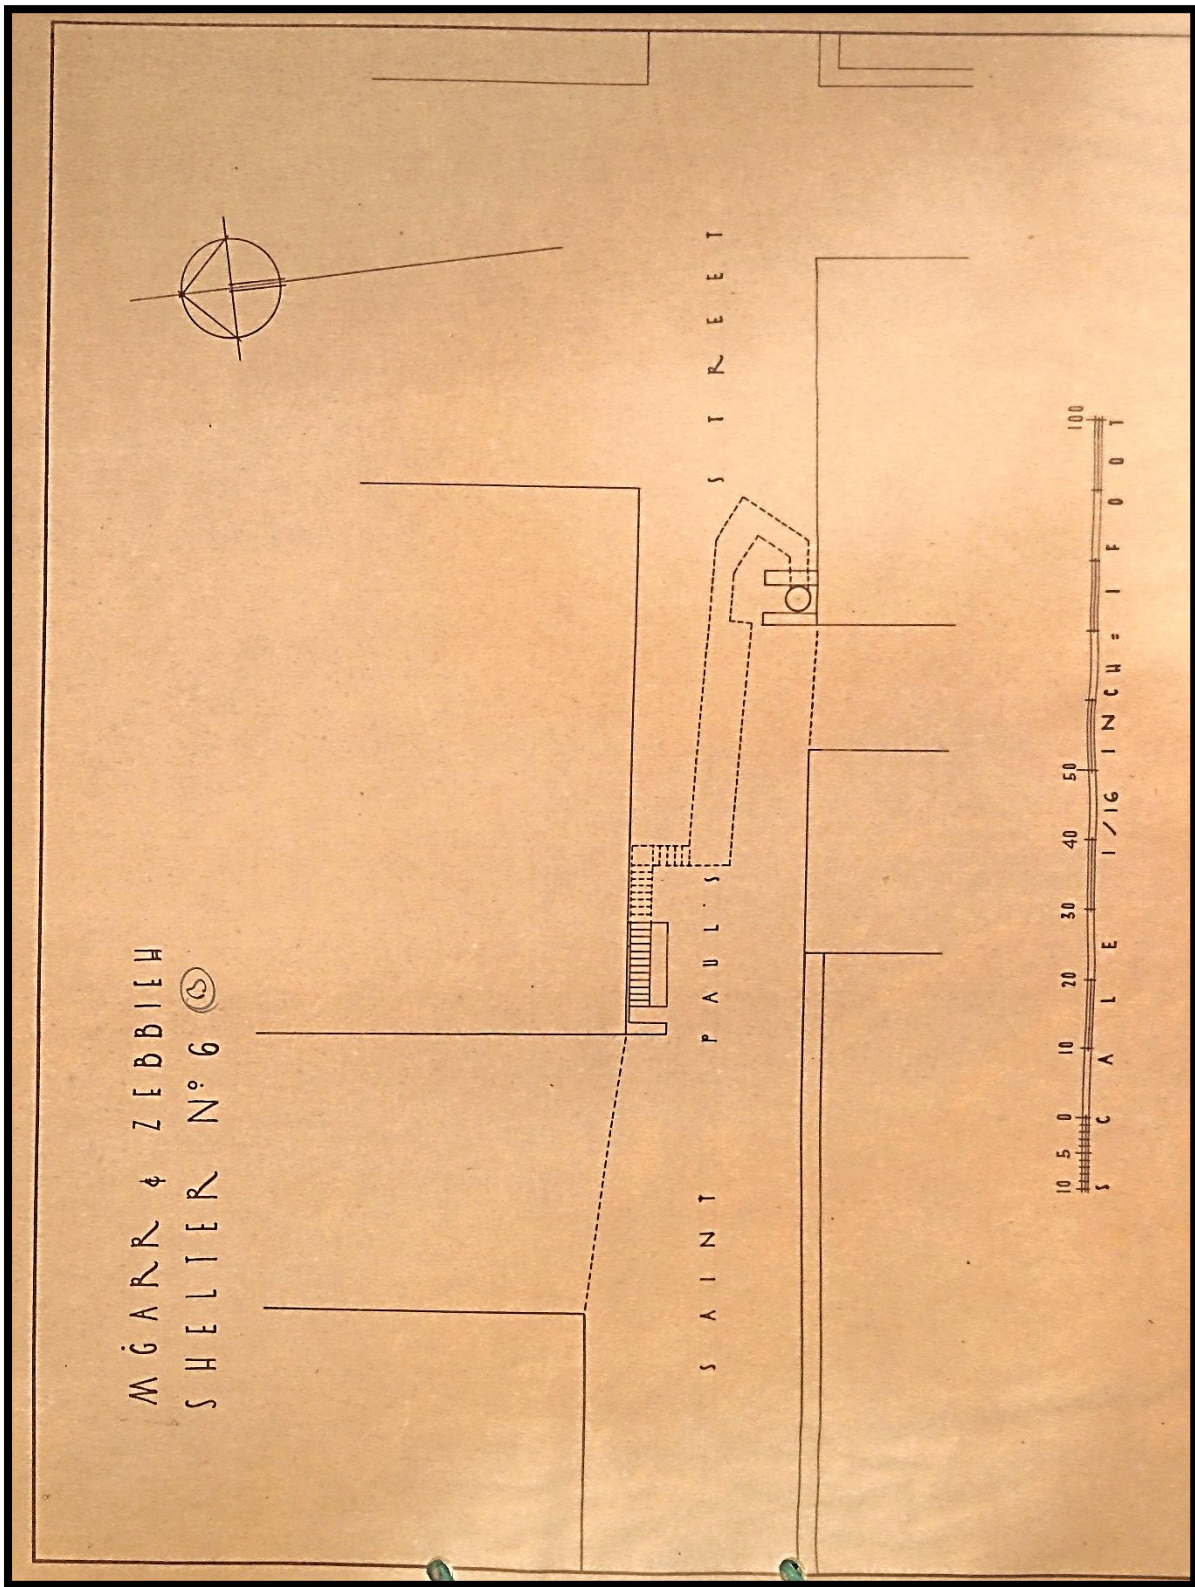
Planta do Abrigo nº6B "Saint Paul's Street"
